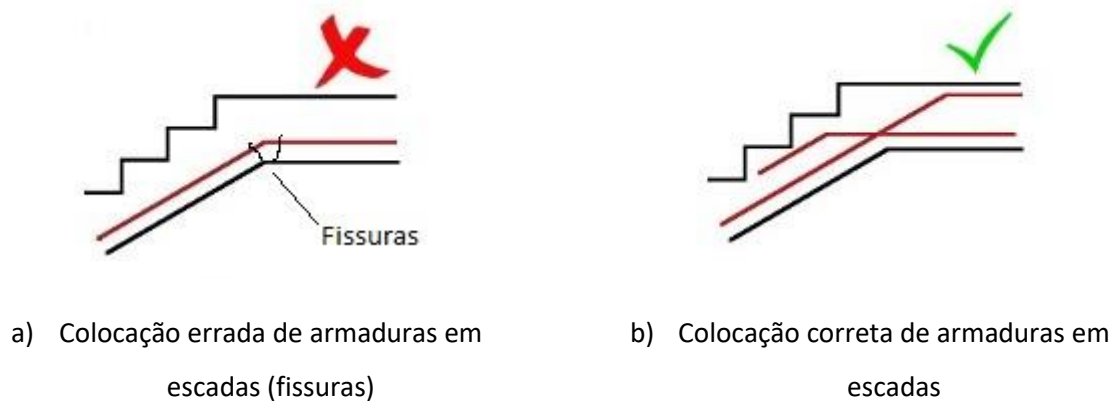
Erros de projeto ou construção (adaptado de E-Civil, 2020)
